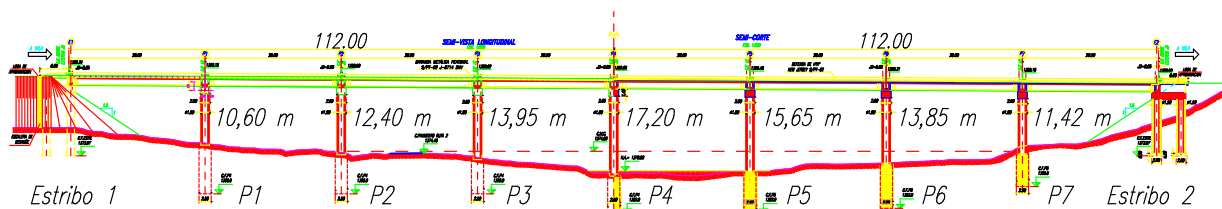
Geometría longitudinal del puente utilizado para ejercitación.
